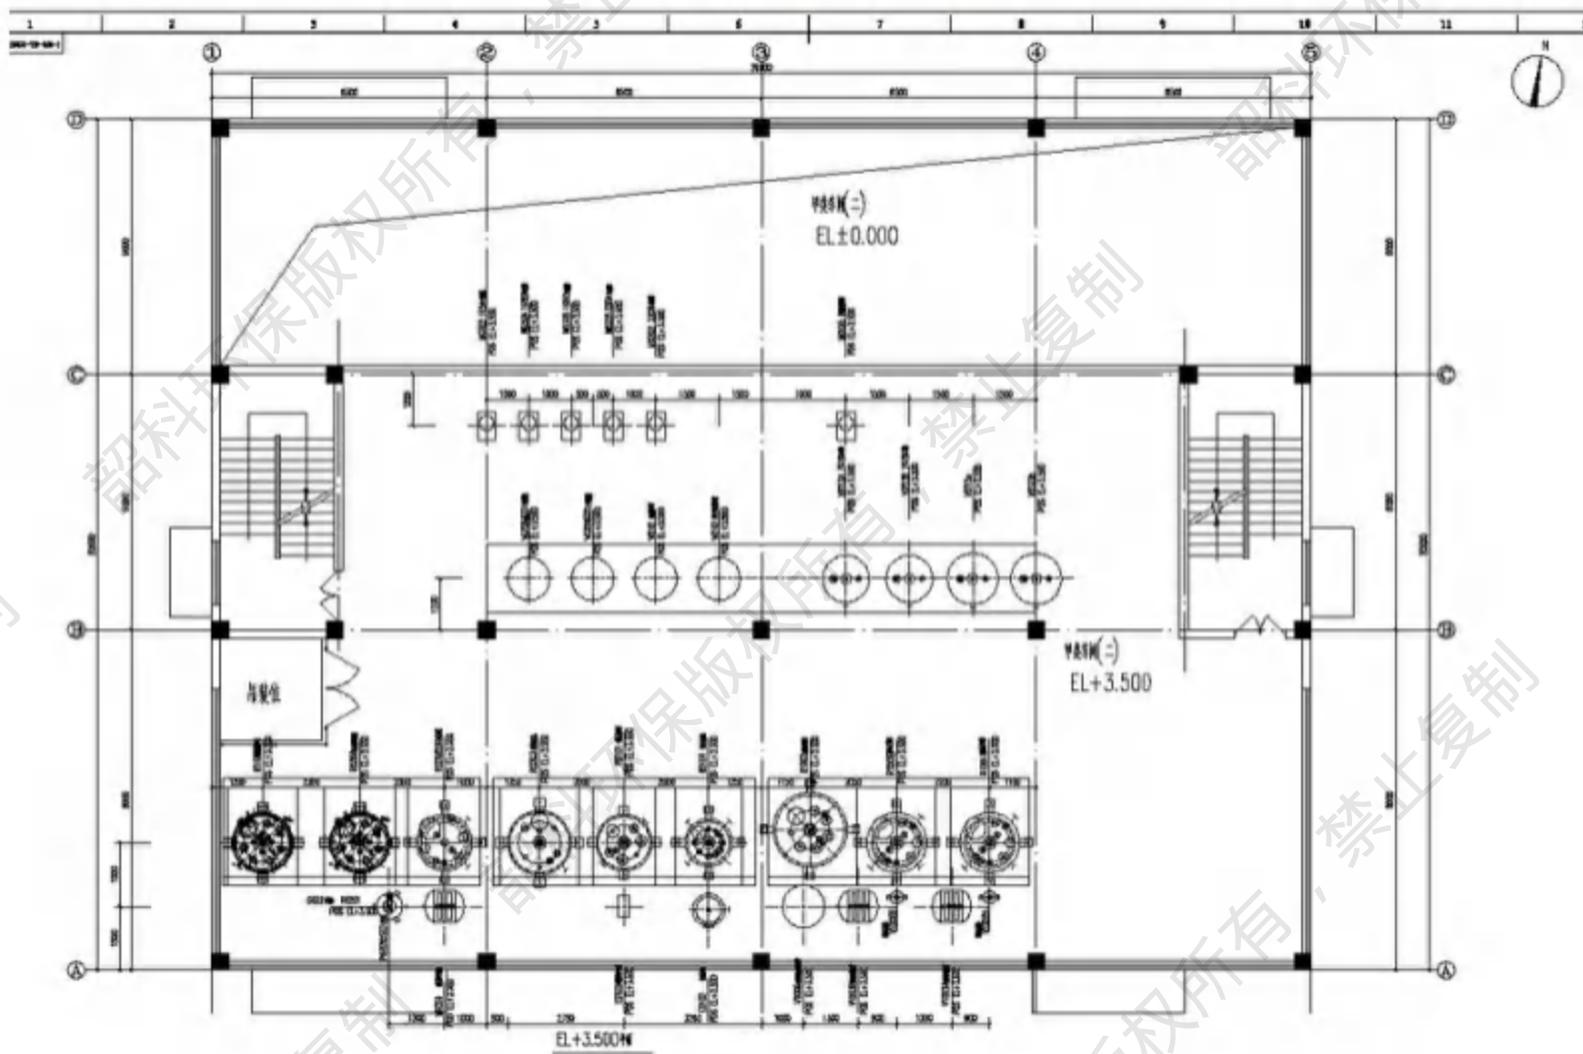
甲类车间二生产设备及环保设施布置平面图（二层）
